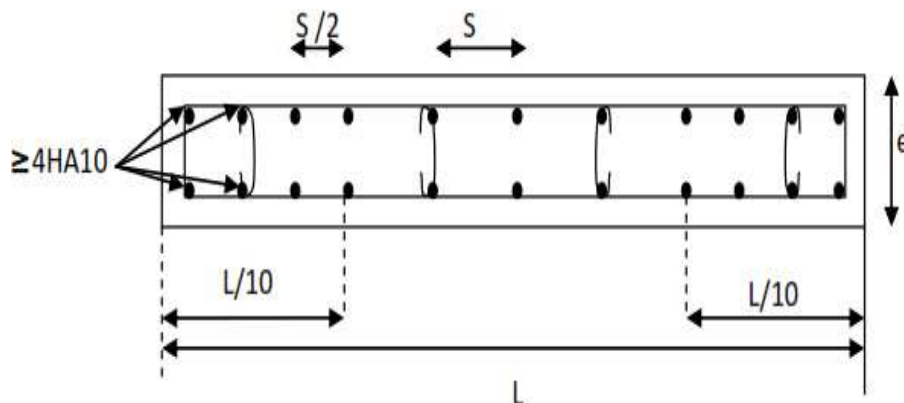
Disposition des armatures verticales dans les voiles.
